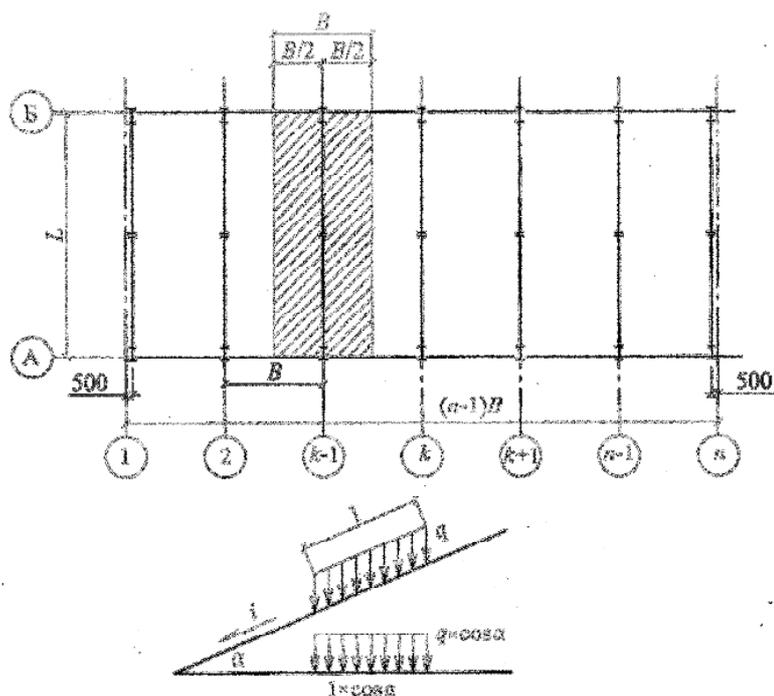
Схема к определению постоянных нагрузок на раму
